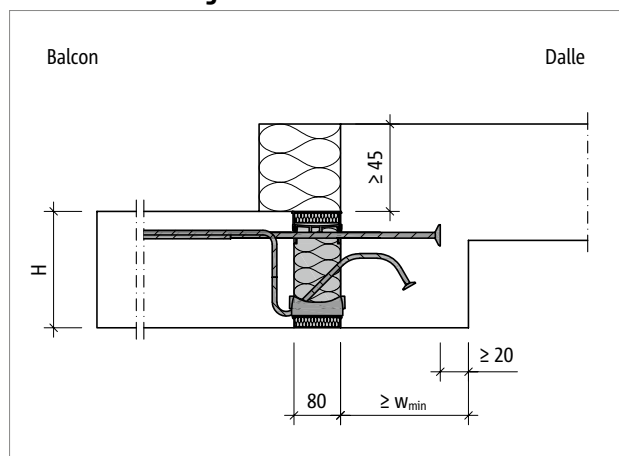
Schöck Isokorb® T type K-U : balcon avec décalage vers le bas et isolation extérieure
